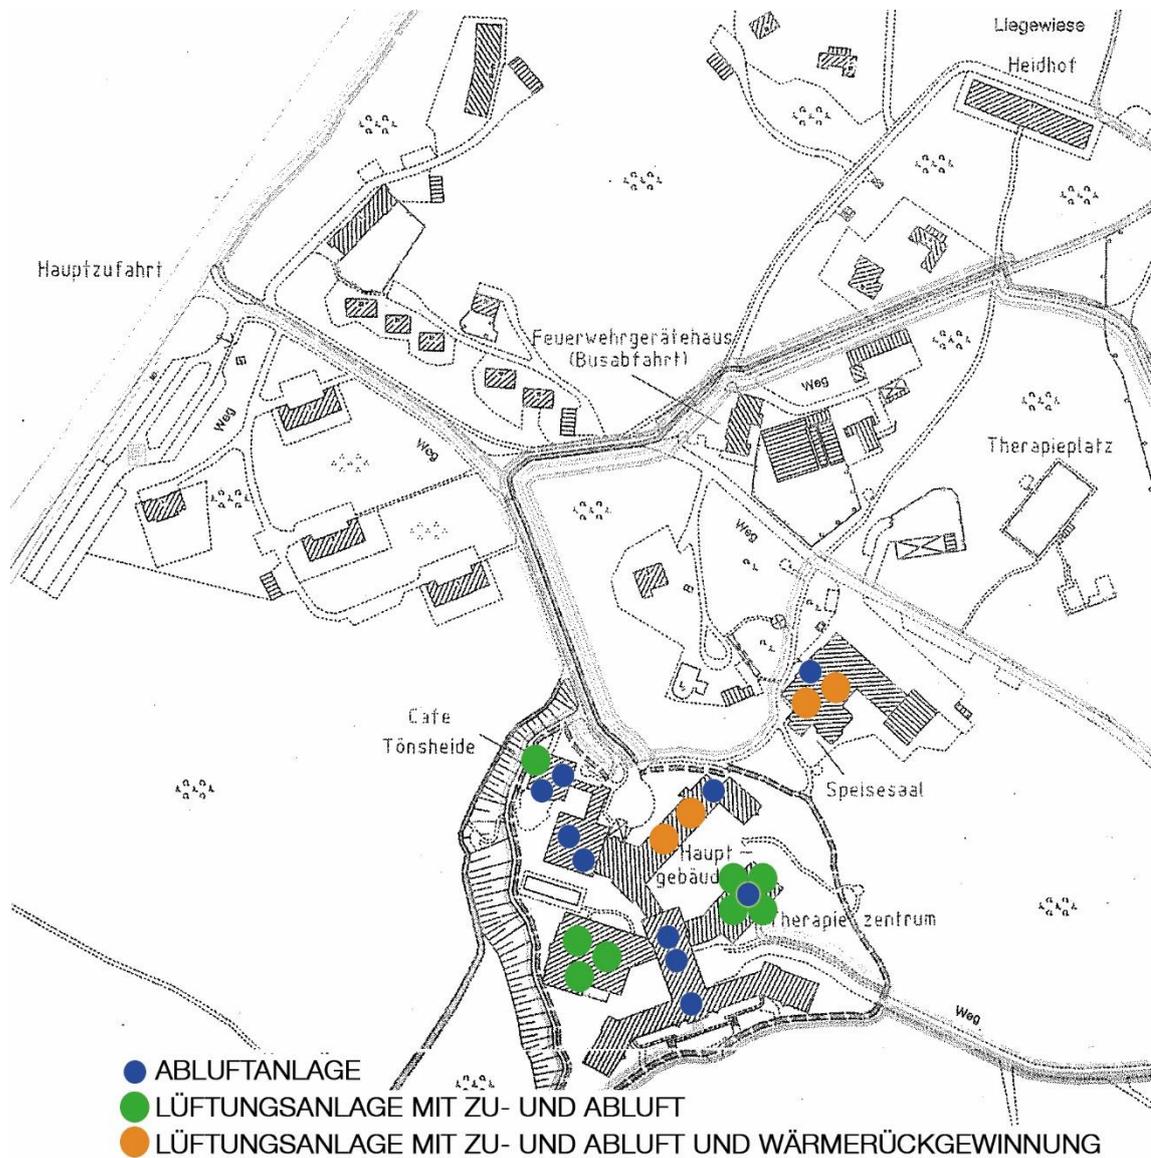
Übersichtsplan Lage und Typ der Lüftungsanlagen
